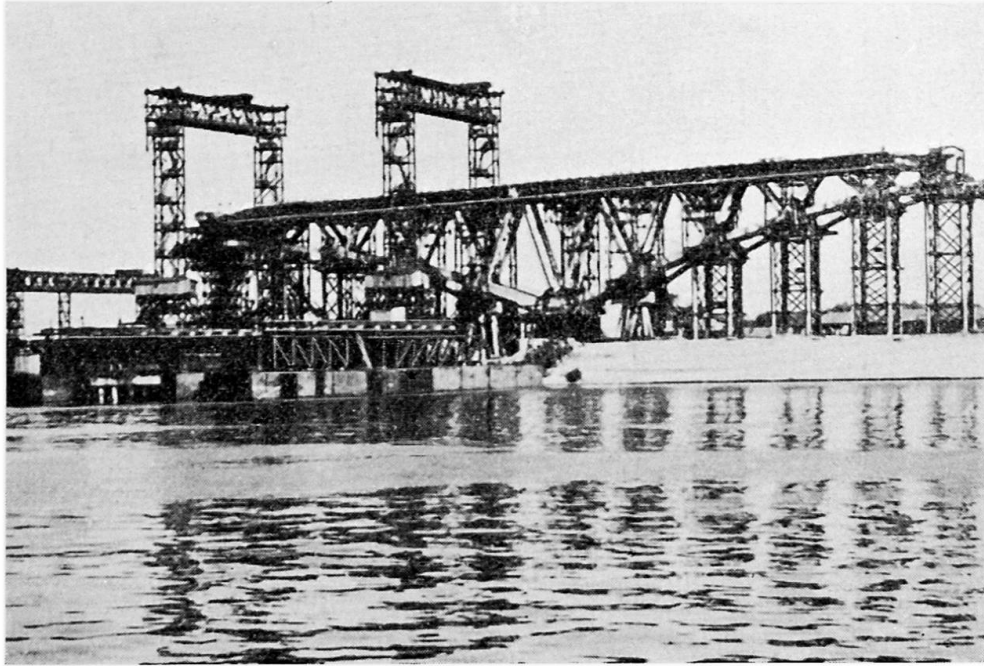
Montage des Raumfachwerks aus Stahlbeton auf dem wiederverwendbaren Gerüst.
